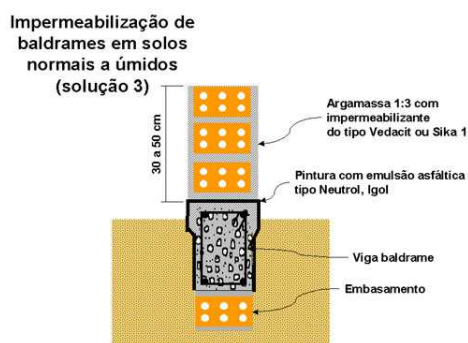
Detalhe 3 - Impermeabilização no Embasamento.
